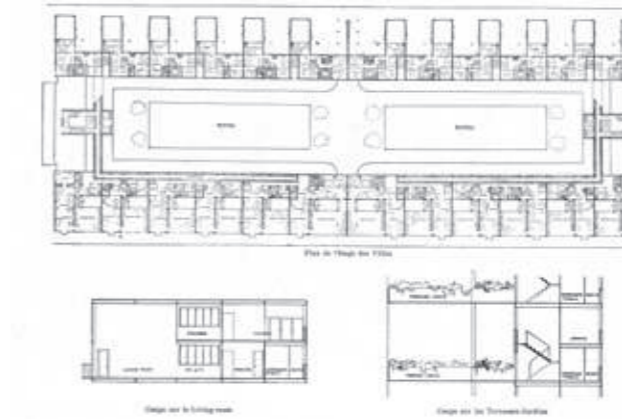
Plano de la planta y las viviendas, Inmuebles Villa, Le Corbusier.
